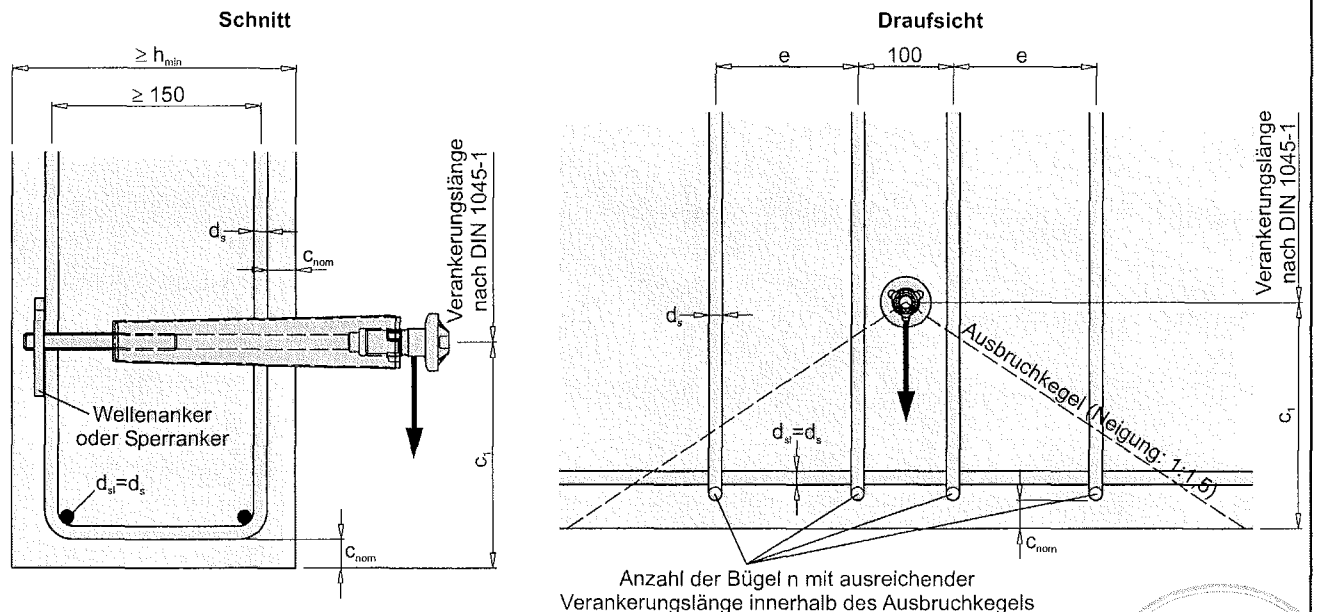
Einbausituation in Wänden - Querbeanspruchung mit Rückhängebewehrung - Bewehrungslage
